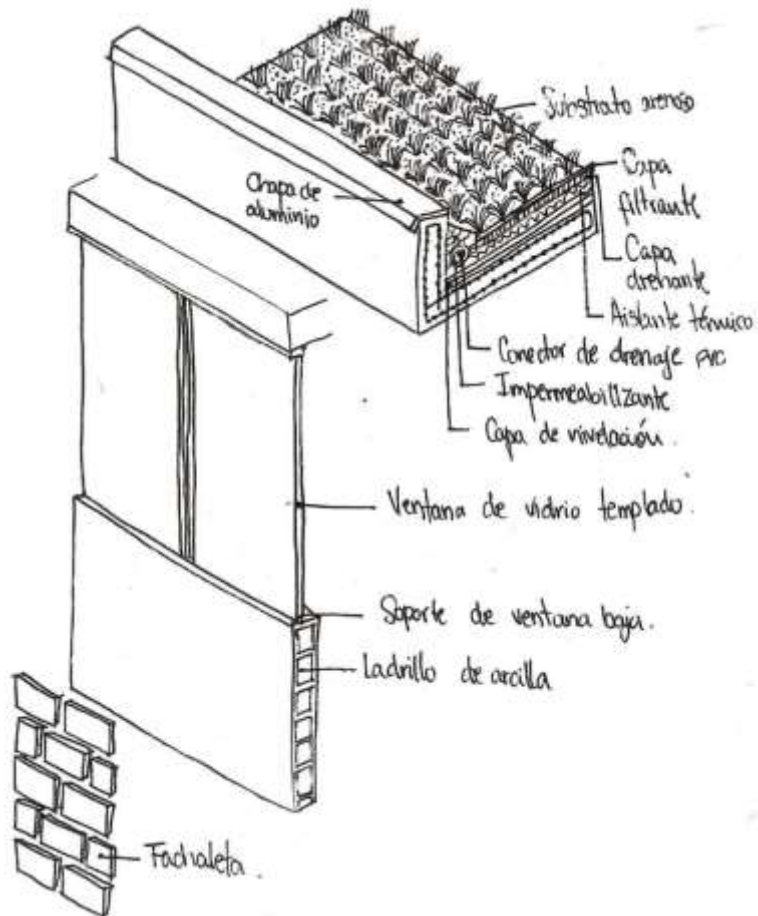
Isometría de muro de albañilería armada en viviendas. Fuente: Elaboración Propia.
